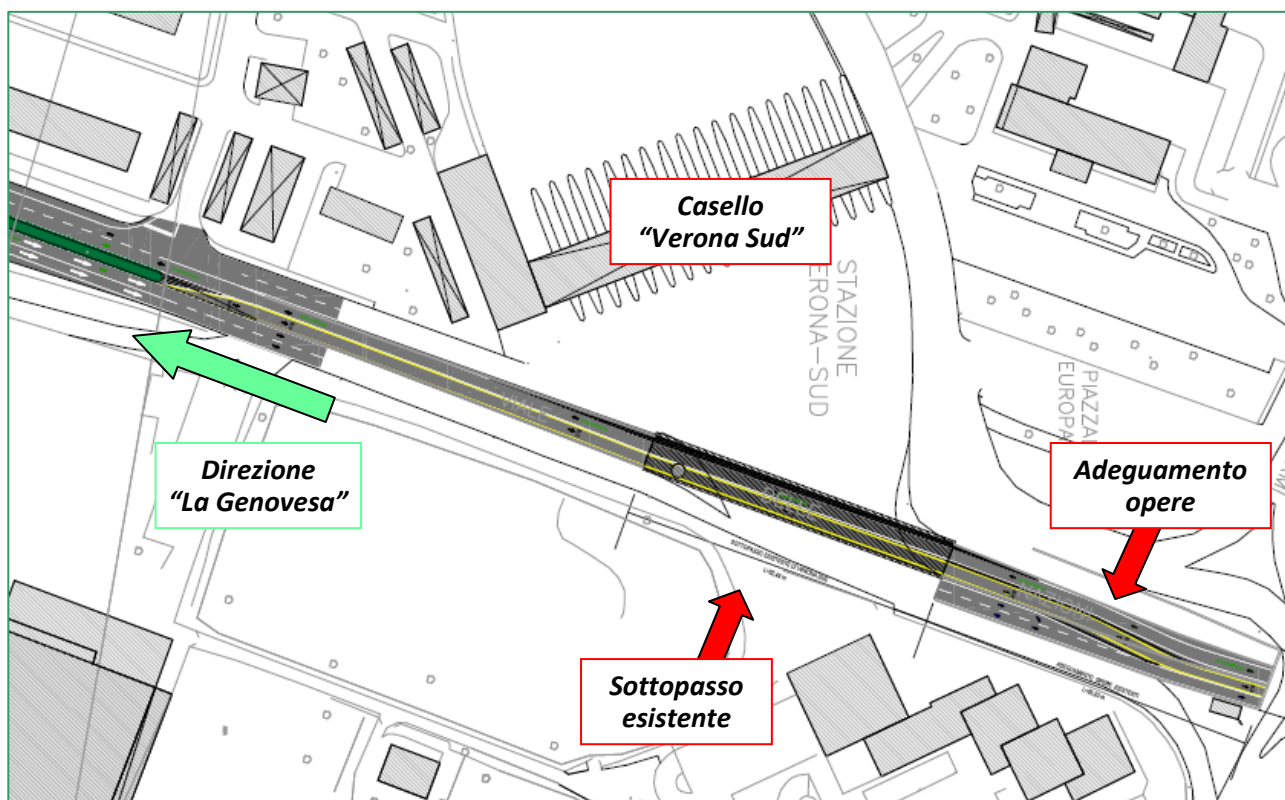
LINEA 2B: Planimetria della soluzione planimetrica per il passaggio del casello di Verona Sud
